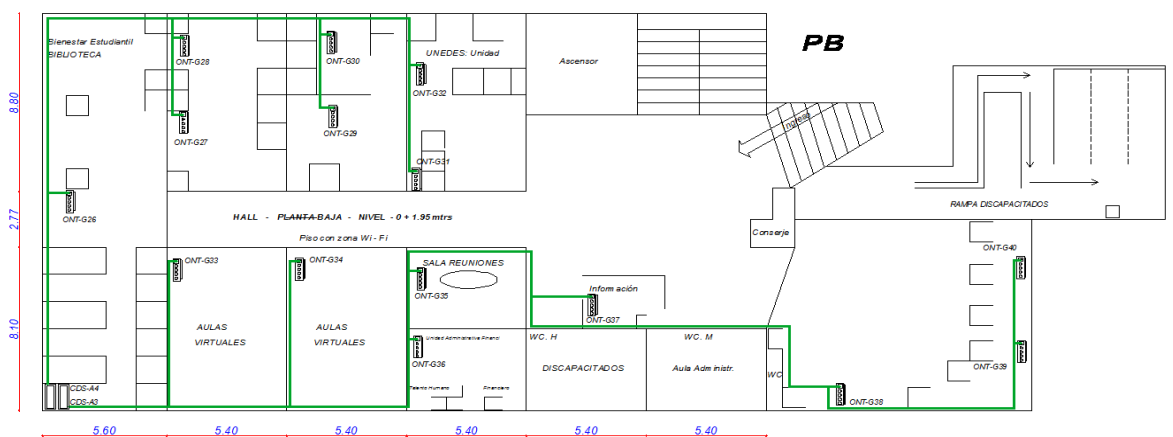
Diseño de la red óptica de la Planta Baja.
